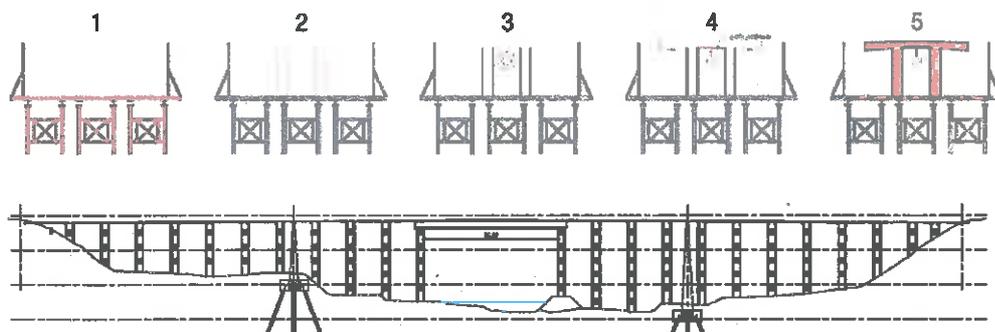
Rappresentazione schematica delle fasi esecutive impalcato (sopra)
